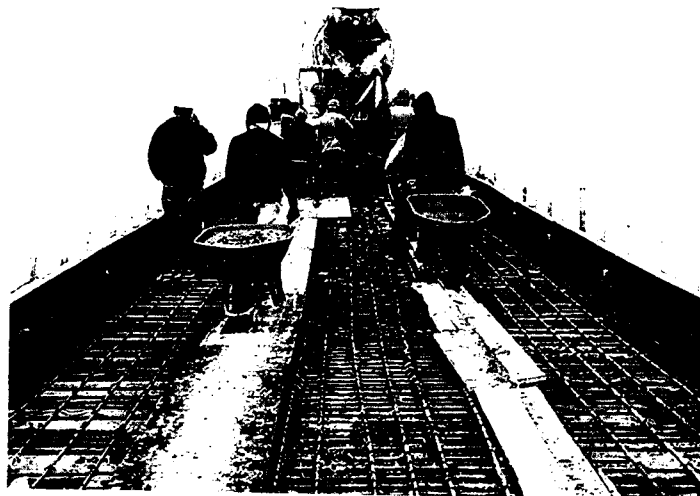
Vaciado de concreto en losa del día 03/07/19
